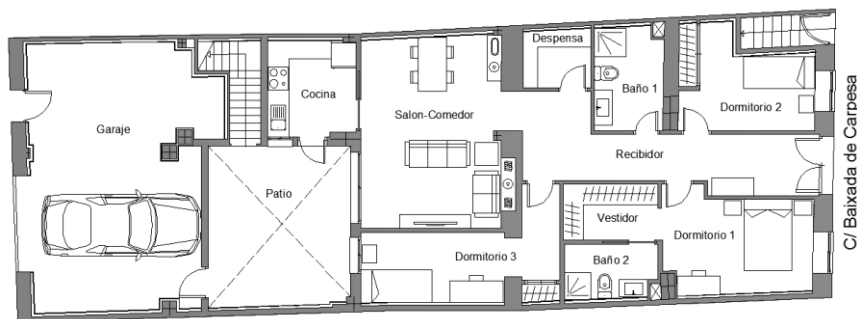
Distribución de la reforma de la vivienda de planta baja. 2014.
